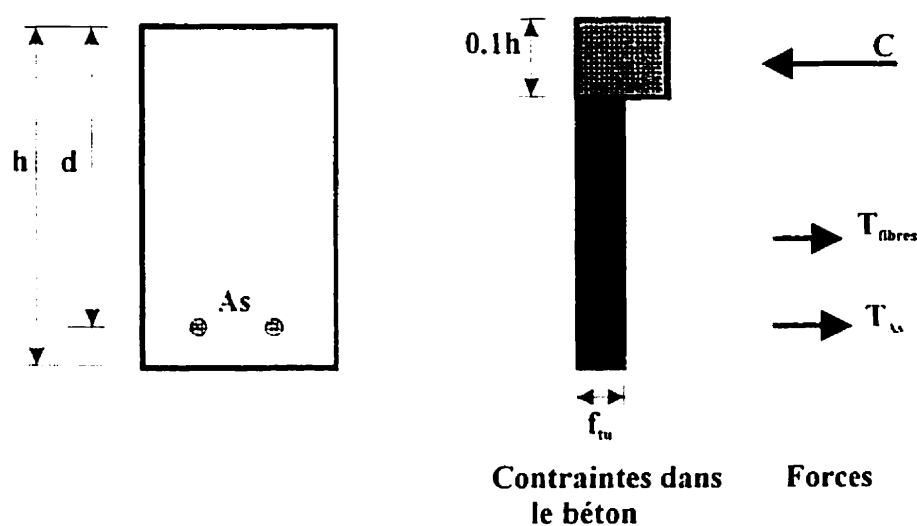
Schéma des contraintes et des forces dans une section de dalle de tablier de pont en béton armé avec fibres d'acier
